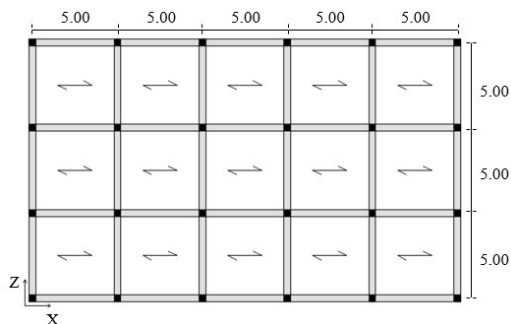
Pianta strutturale degli edifici caso studio (unità di misura: metri)
